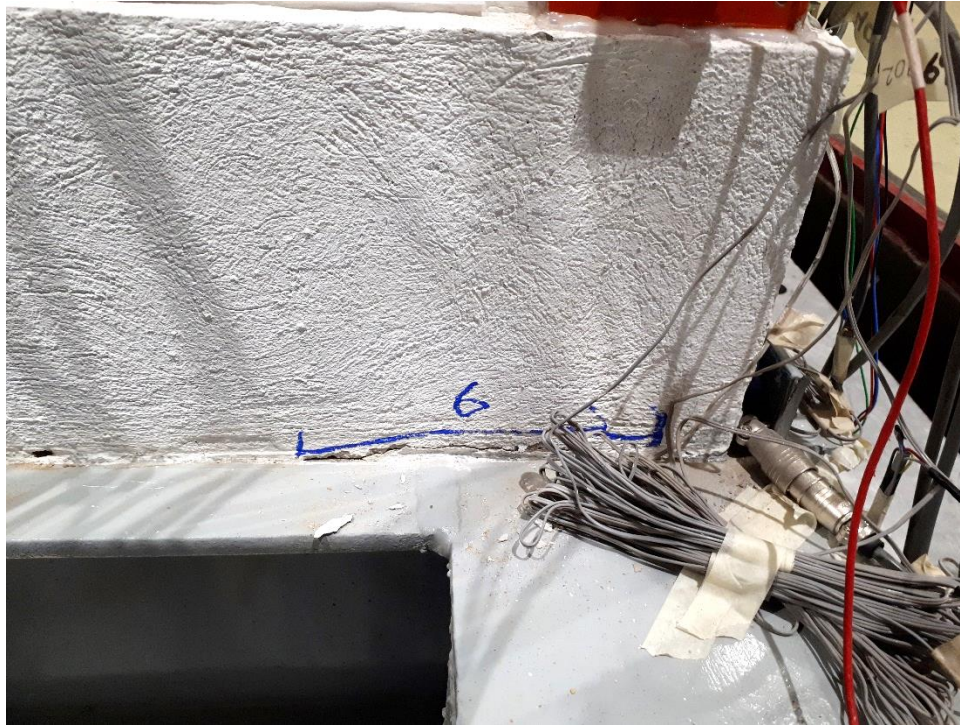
Detalle de agrietamiento en dala de cimentación en esquina suroeste (previo al refuerzo, durante la primera etapa de ensayos)
